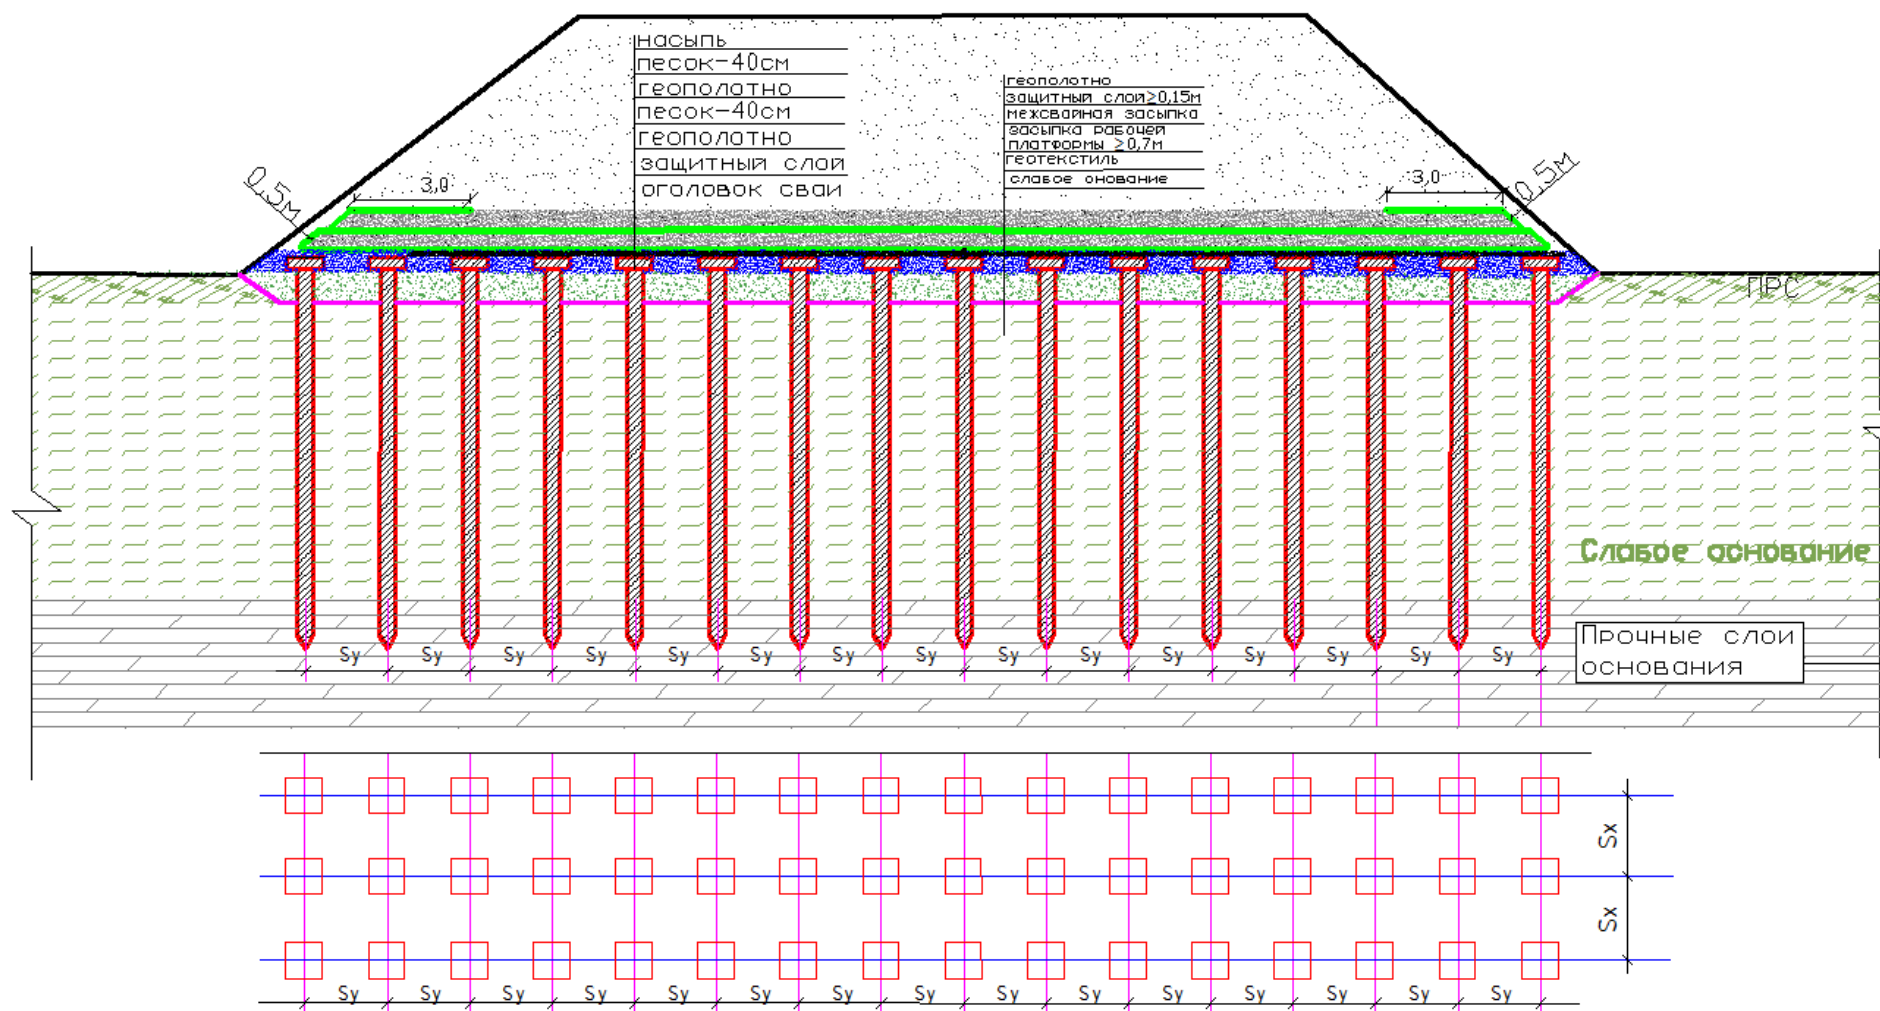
Гибкий ростверк из двух слоев геополотна на железобетонных сваях с оголовками (с размещением свай по квадратной сетке)
